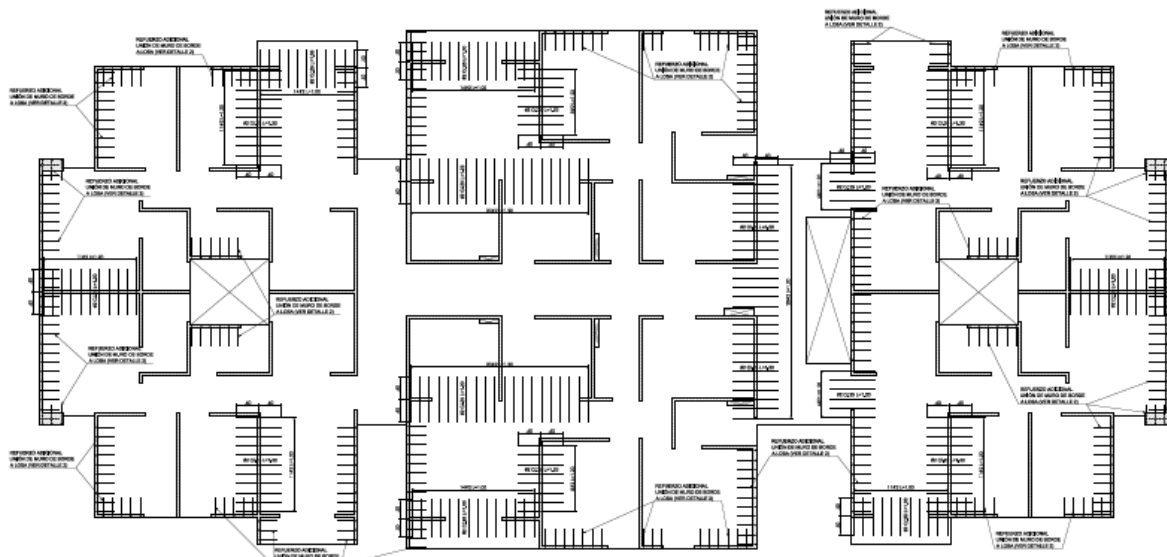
Planta refuerzo adicional en losas. Fuente: Imágenes de planos DUAL INGENIERÍA ESTRUCTURAL SAS. Archivo personal, recuperado en el 2017.
